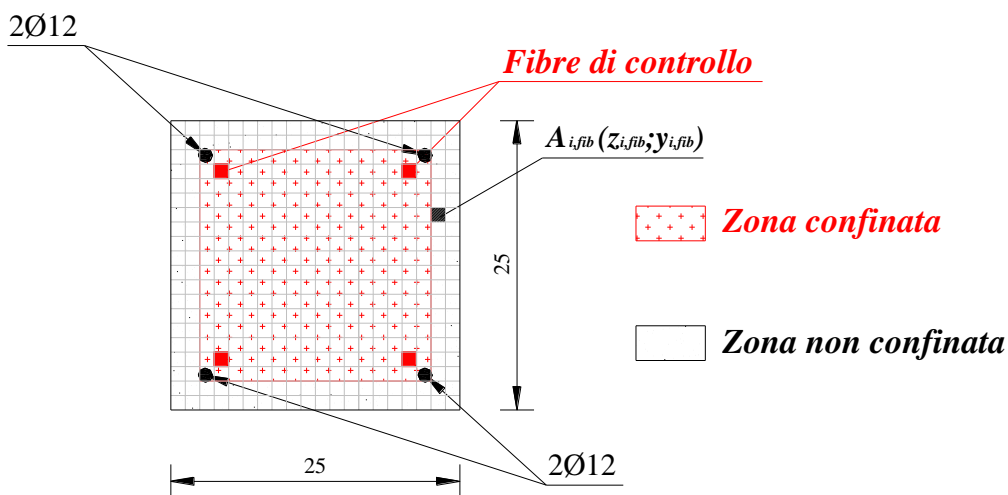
Schema della Disposizione delle fibre di controllo nei pilastri.
